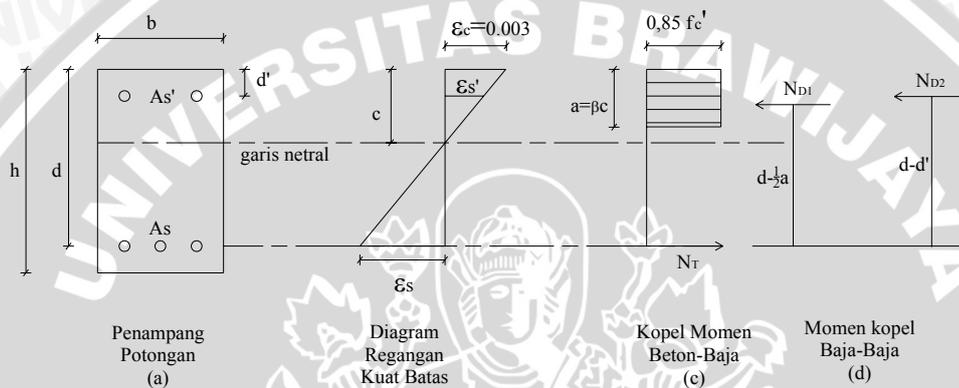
Penampang Balok dengan Penulangan Kurang
